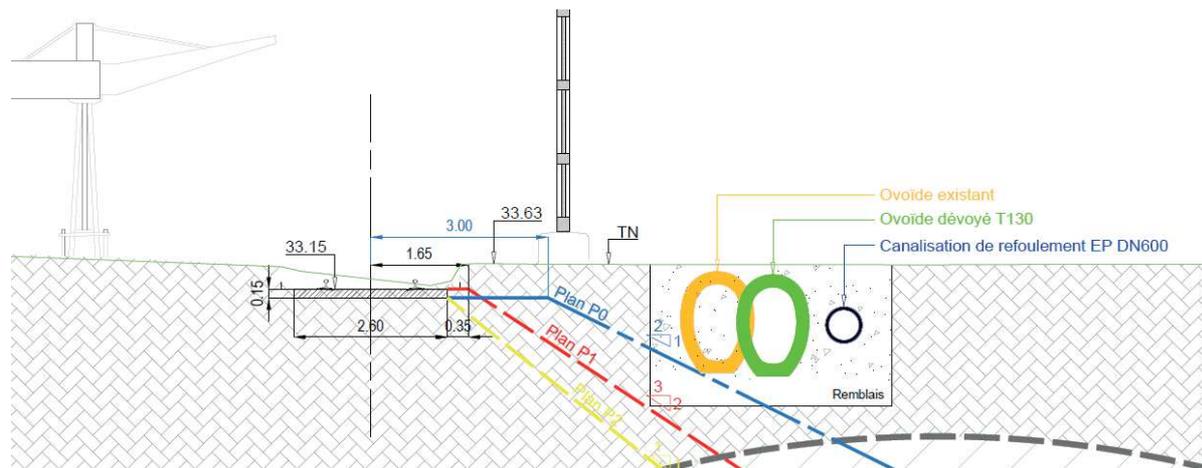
Coupe sur canalisations – CT05 (Coupe CC' Architecte)
